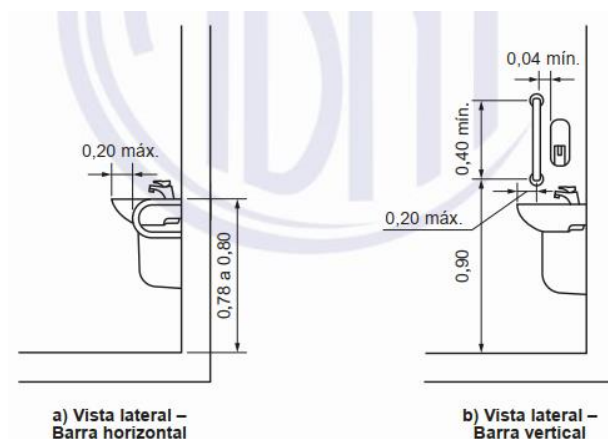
Barra de apoio no lavatório – Vista lateral
